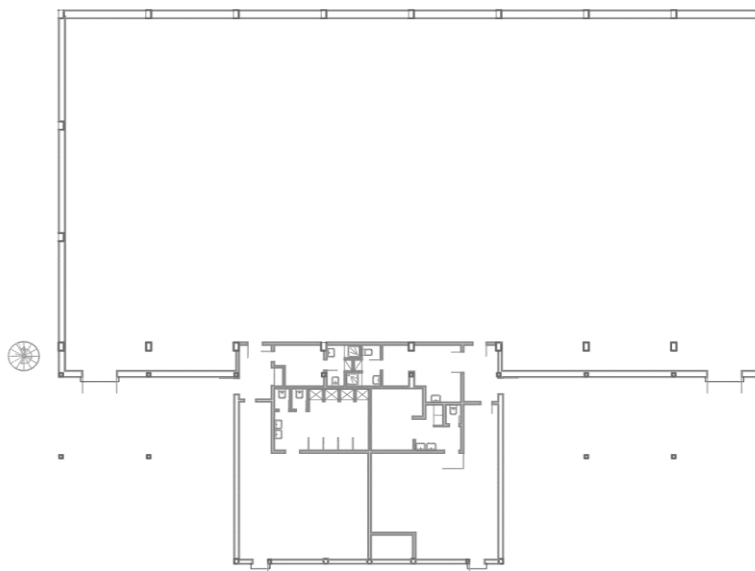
Planta do Pavilhão gimnodesportivo
